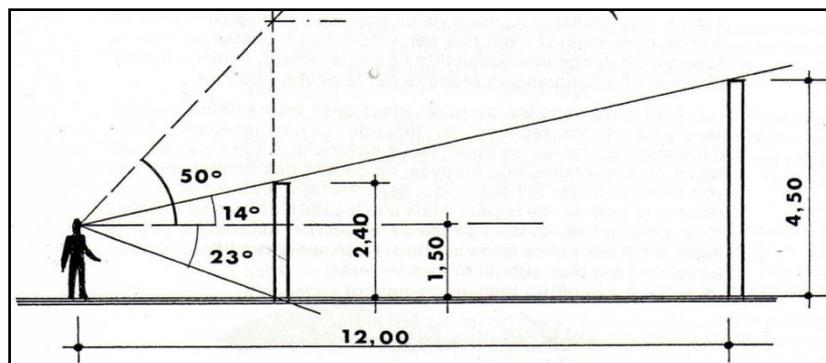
Le rapport entre la distance d'éloignement et la hauteur de la façade.
